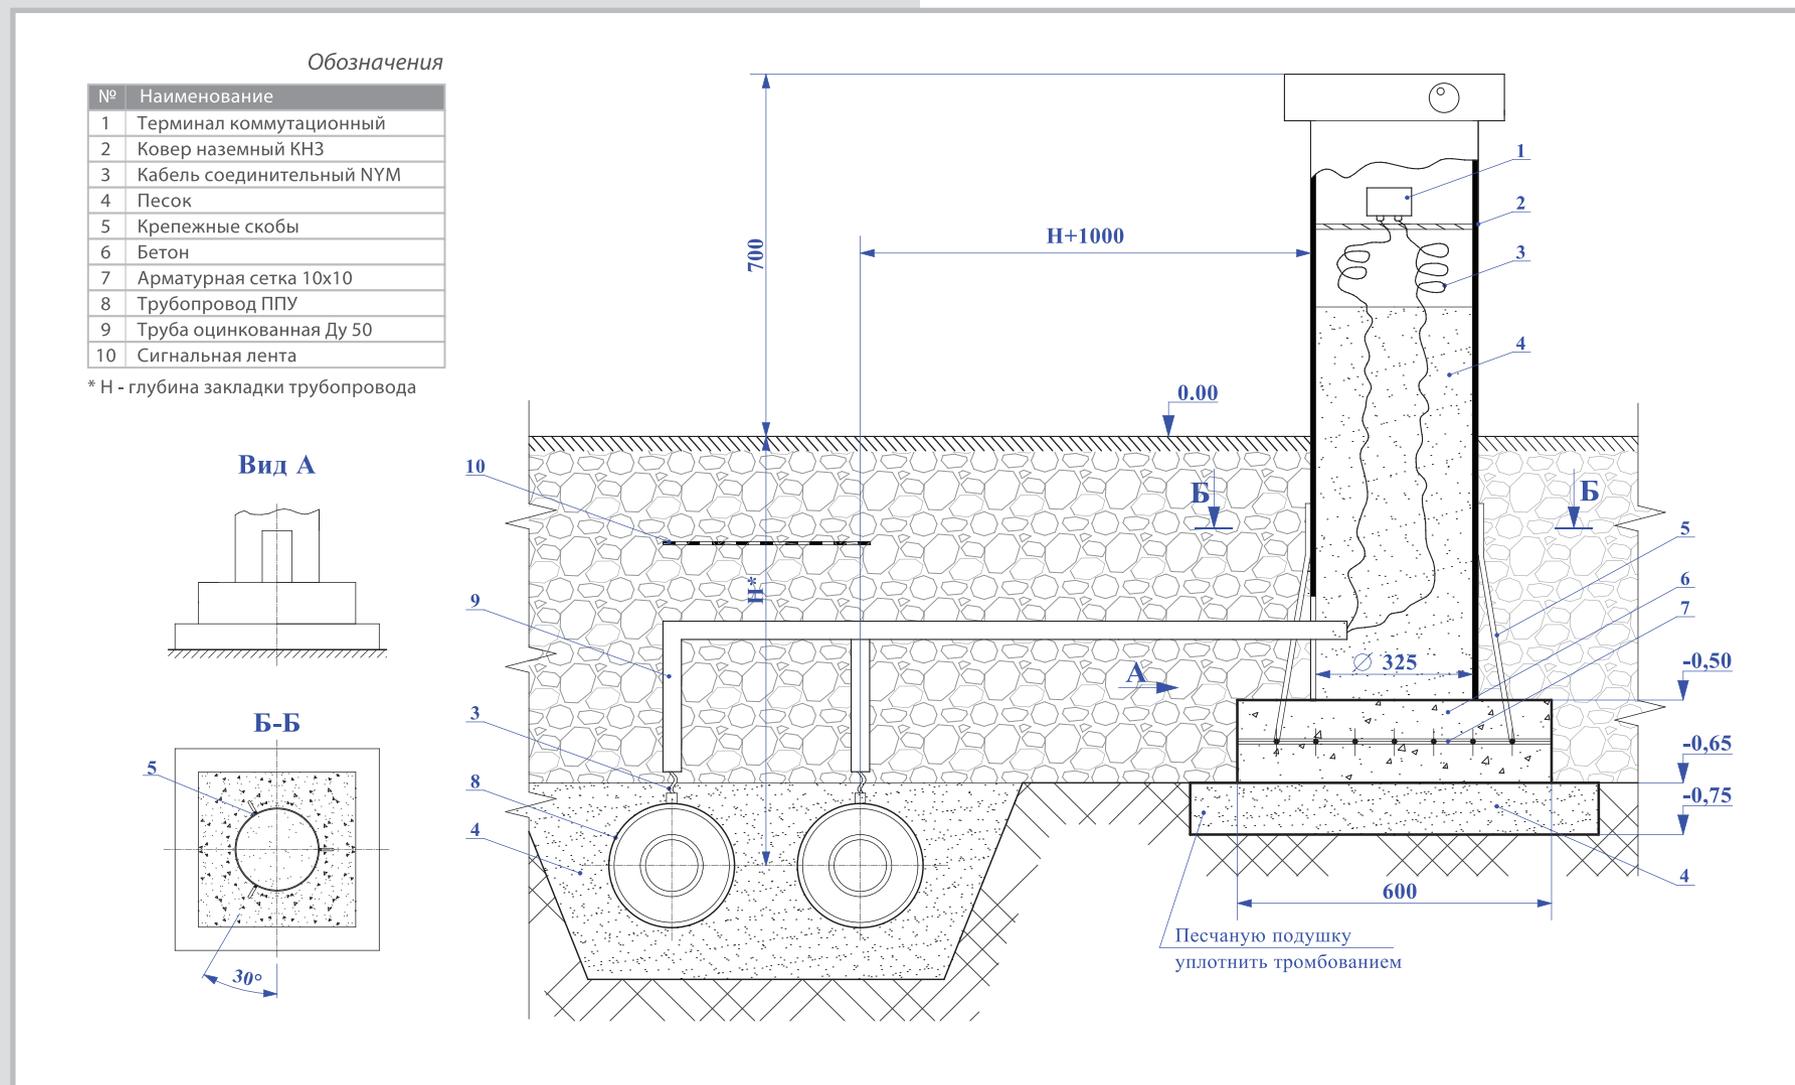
Монтажная схема установки ковра наземного КНЗ в промежуточной ТК без тепловой камеры (для характерных точек 3, 8, 10, 13)
